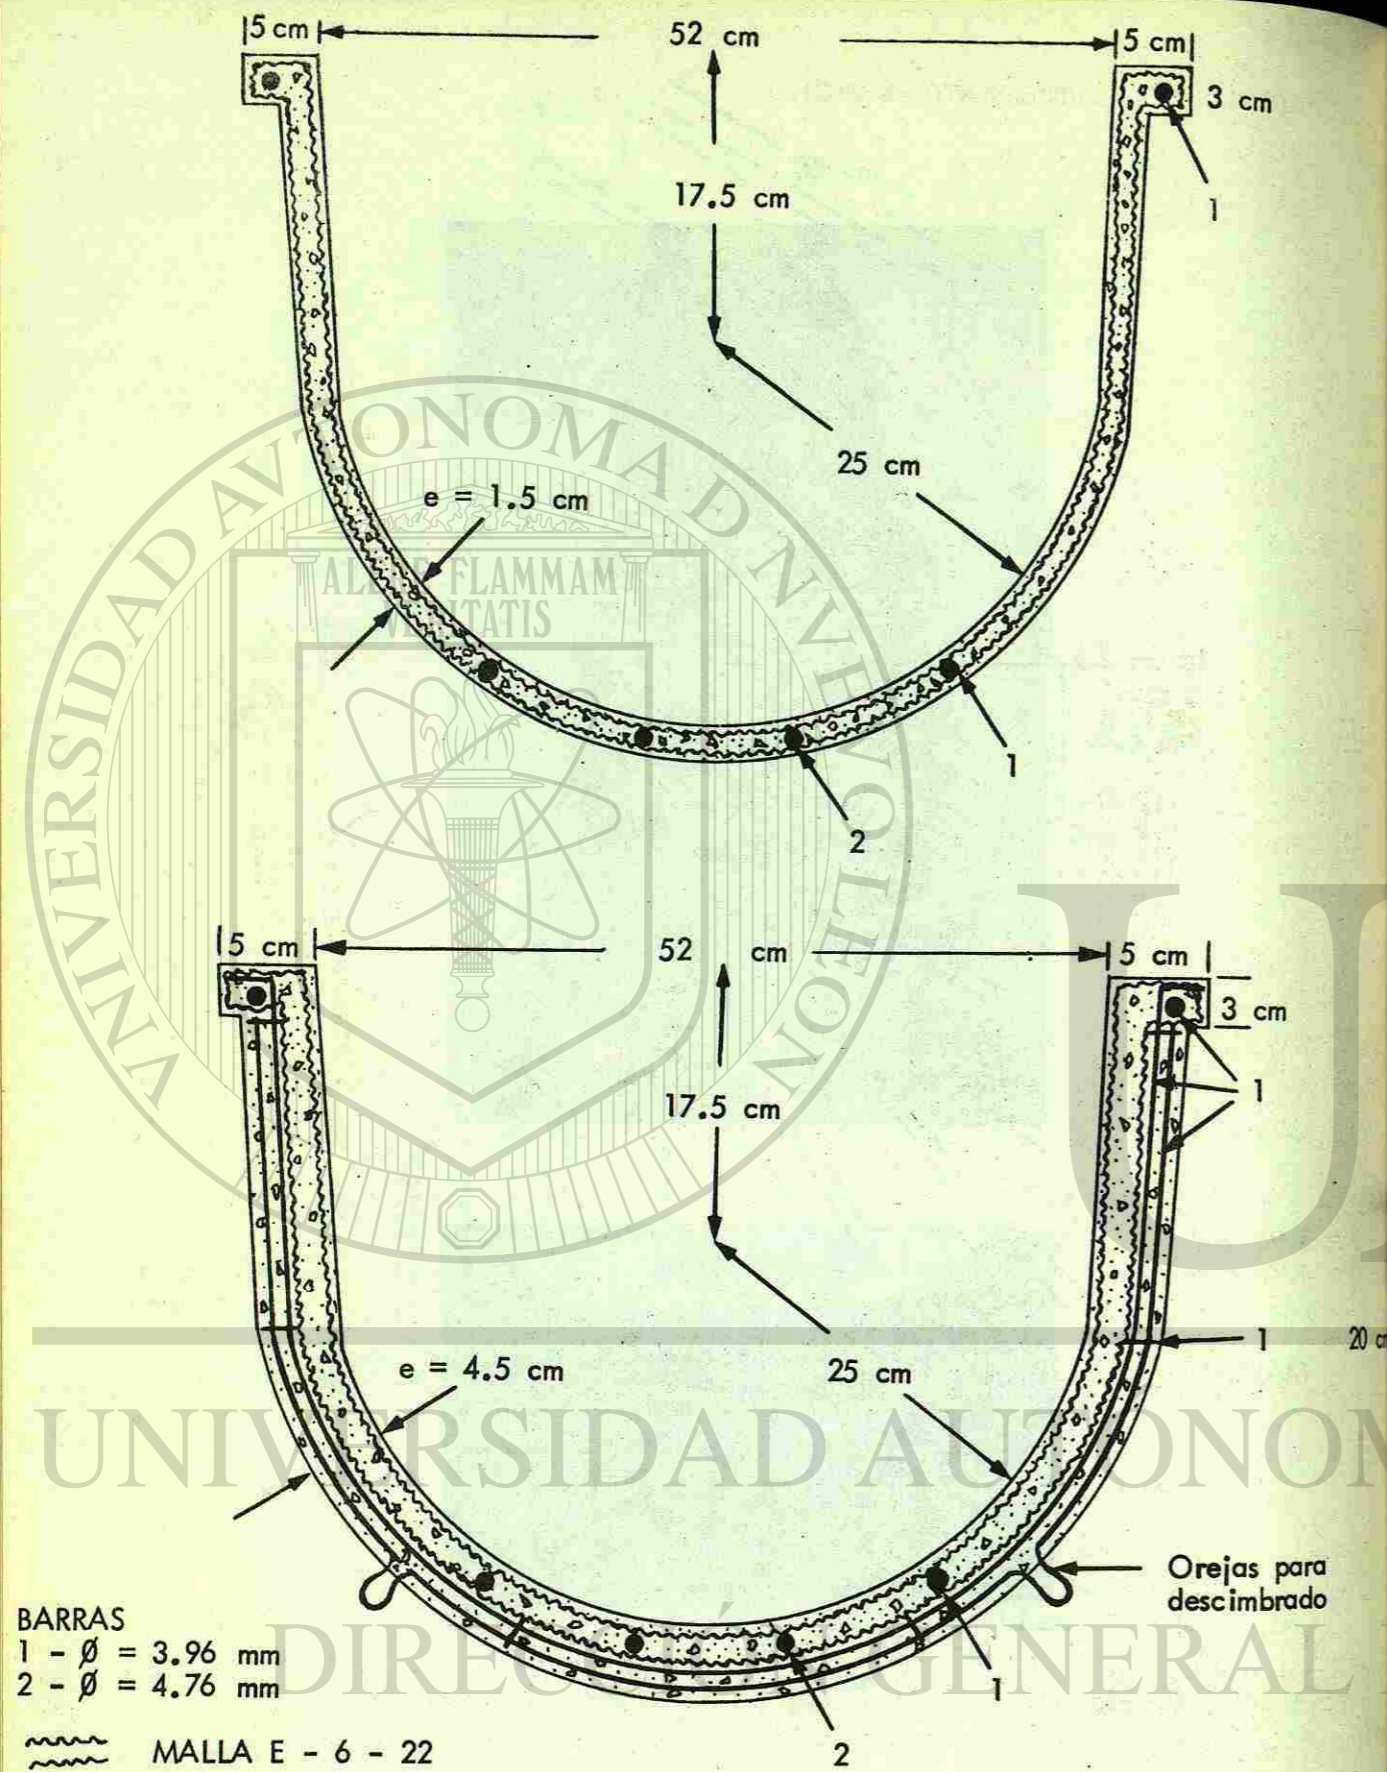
DETALLES DE ARMADO DE LA SECCION Y NERVADURAS
